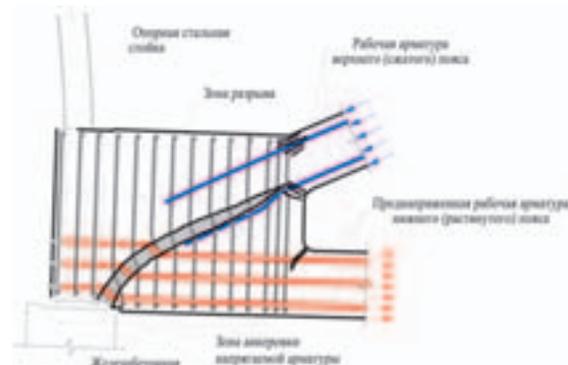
Схема завершающей стадии трещинообразования, иллюстрирующая наиболее вероятный механизм разрушения опорного узла фермы пролетом 24 м серии 1.463.1-3/87 с проектным армированием. После образования сквозной трещины, пересекающей зону анкеровки предварительно-напряженной арматуры нижнего пояса, усилия отрыва воздействуют на поперечную арматуру по нагельной схеме
